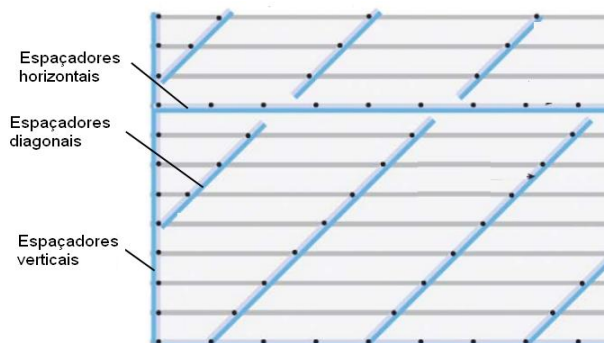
Disposição dos espaçadores. Adaptado de [13].
